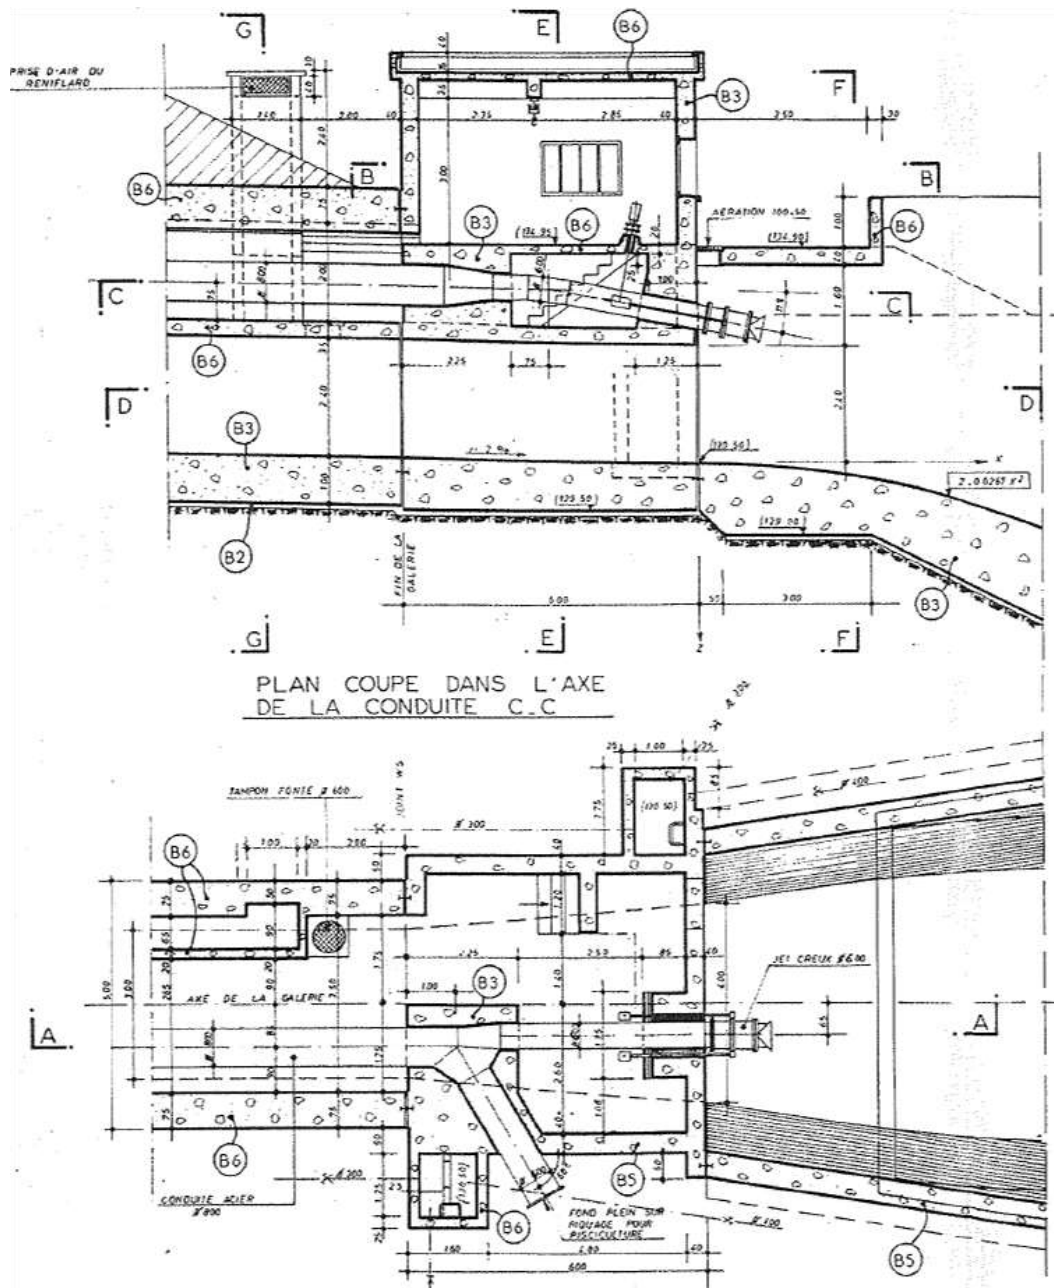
Coupe longitudinale et vue en plan de la tête aval (Dossier définitif, EPTB Elorn)
